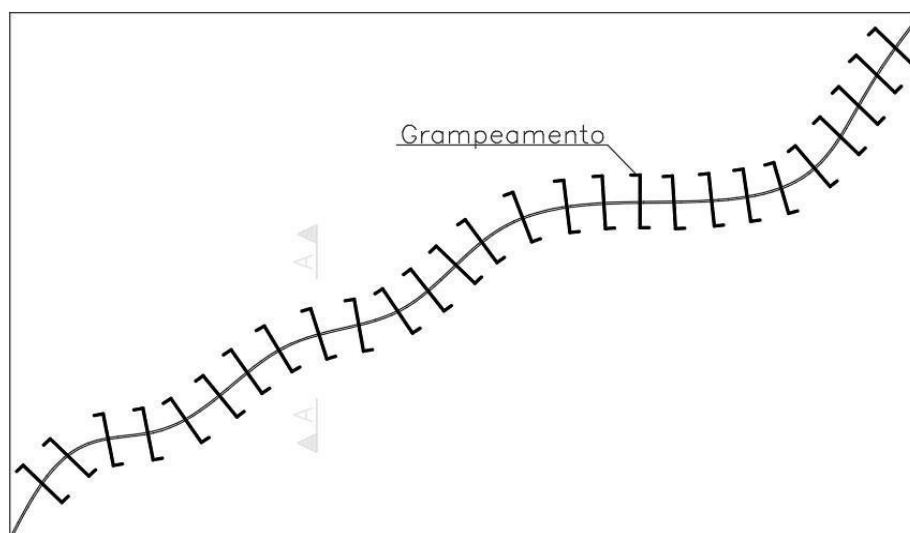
Método de costura das fissuras em paredes ou pisos.
